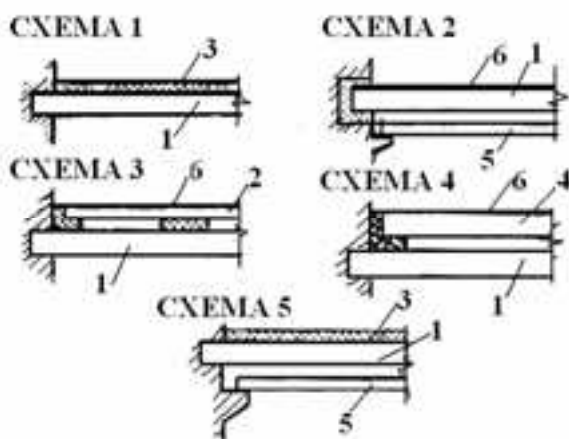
Схеми звукоізоляції перекриття: 1 – зі шаруватим покриттям підлоги; 2 – з роздільним покриттям; 3 - з роздільною стелею; 4 – роздільне перекриття з двох несучих панелей; 5 – з роздільною стелею та шаруватим покриттям підлоги; 1-несуча панель; 2-панель підстави роздільної підлоги; 3-тепла звукоізолююча шарувата підлога; 4-несуча панель підлоги; 5-панель роздільної стелі; 6-покриття підлоги.
